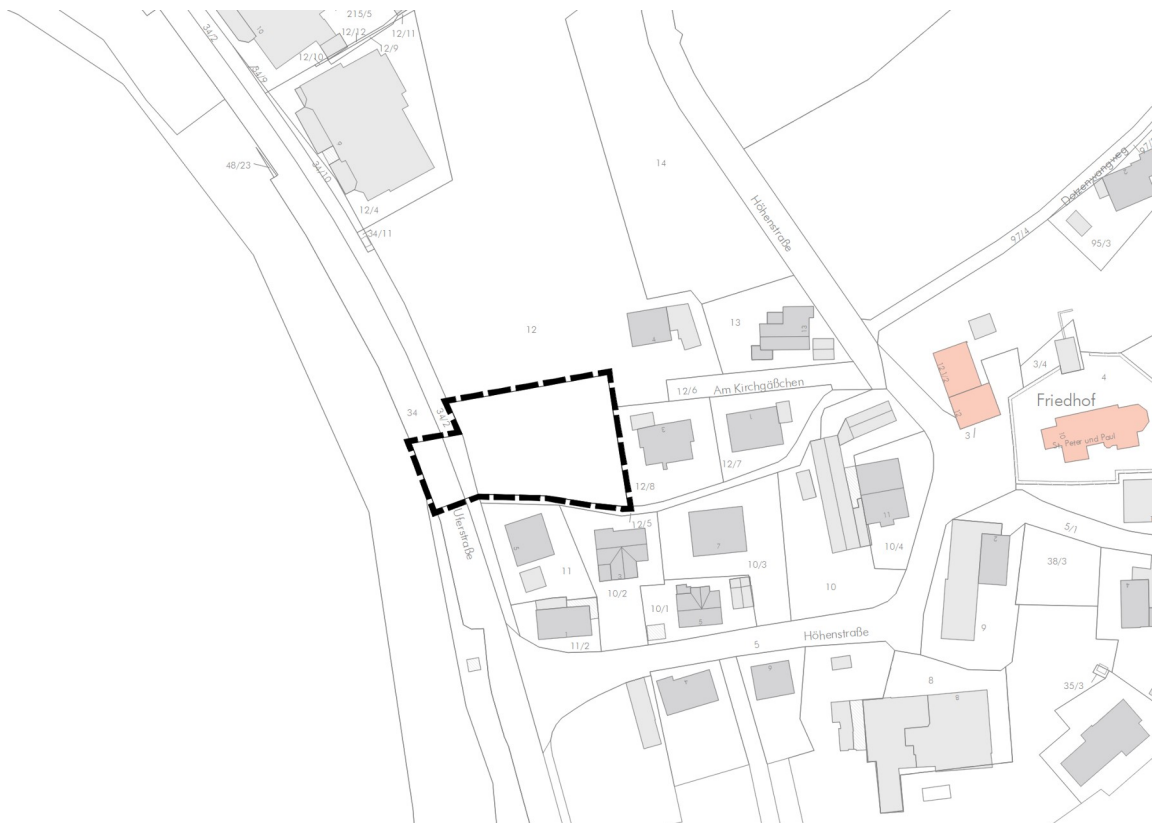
Lageplan der gegenständlichen Bauleitplanung, unmaßstäblich
